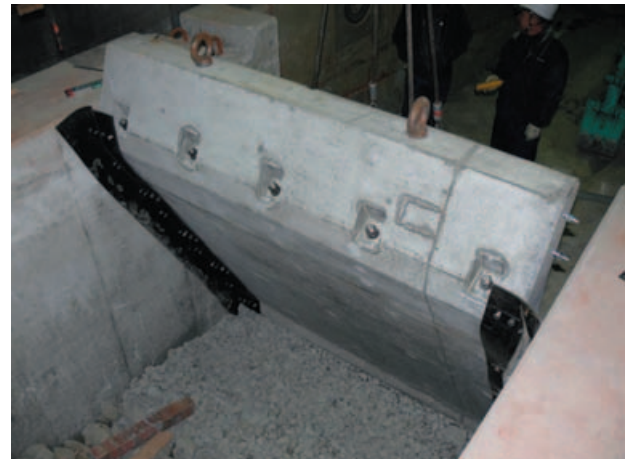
実験模型設置状況 (写真中央は連結ボルト)
